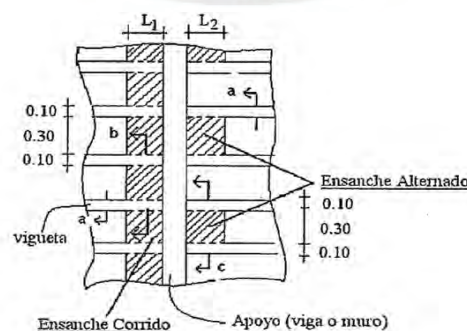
Vista en planta de los ensanches corridos y alternados, (Ottazzi,2016)
